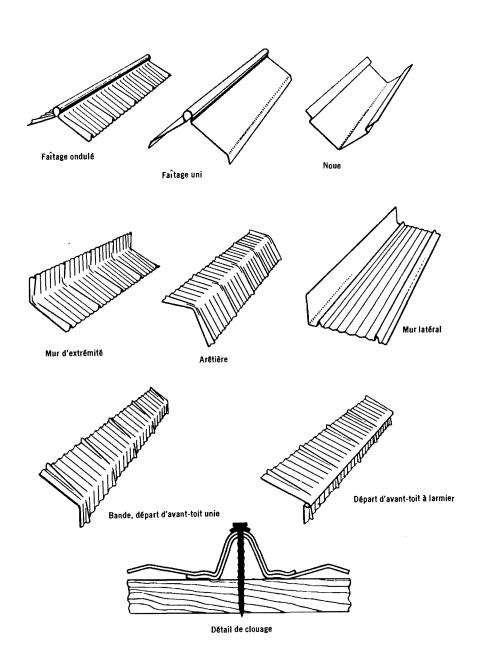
M ACCESSOIRES DE PAREMENT D'ALUMINIUM ET D'ACIER
